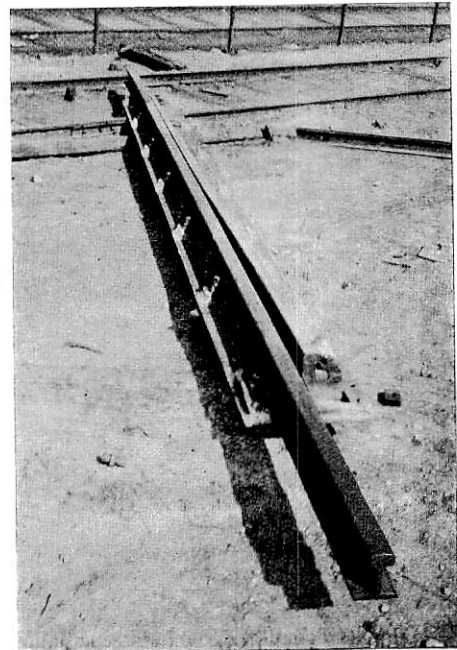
Halbe Weiche. Gleistühle und Drehpunktplatte sind angeschweißt.
